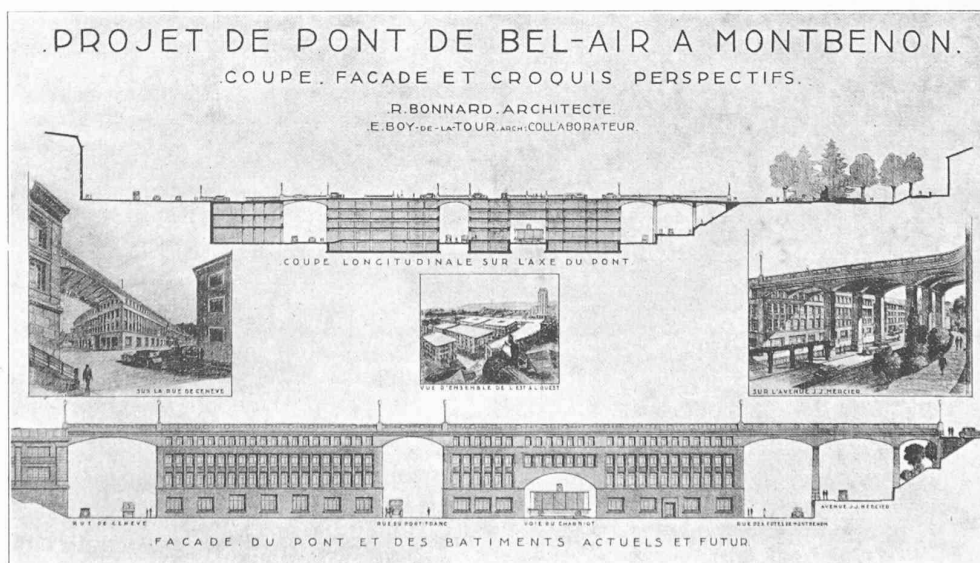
Coupe longitudinale : échelle 1 : 2400.
